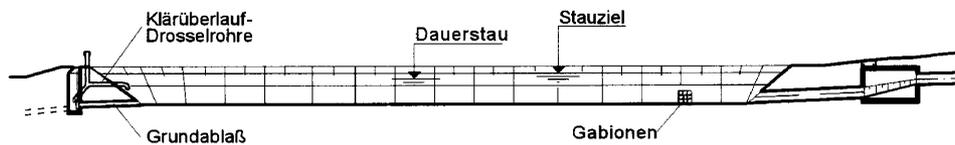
Regenklärbecken mit Dauerstau in Erdbauweise
